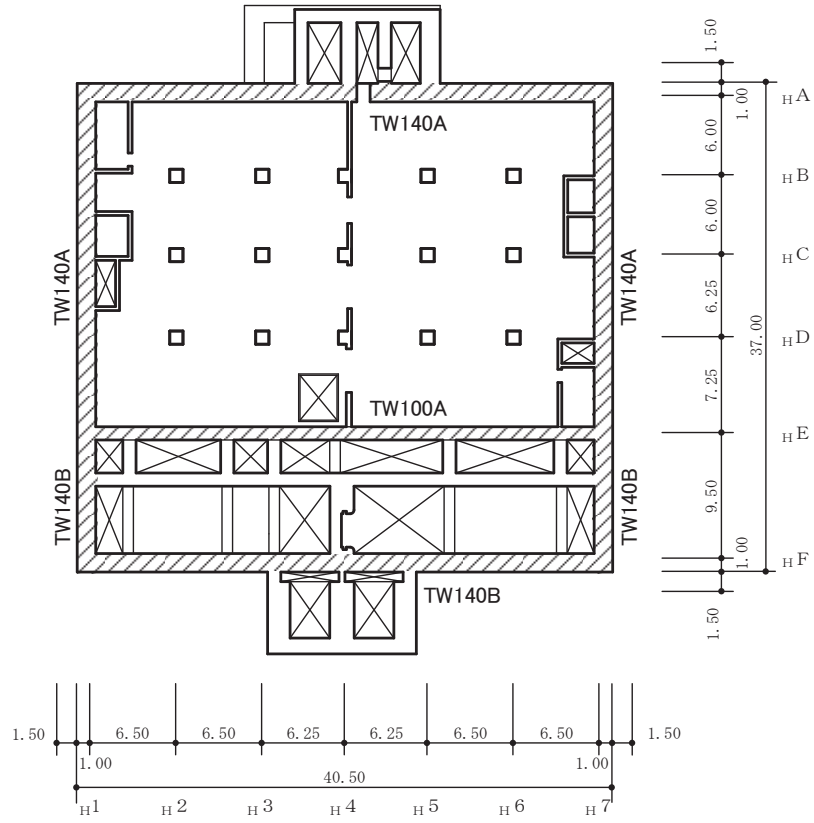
耐震壁配置図 (0.P. -1.1m~0.P. 8.0m)
